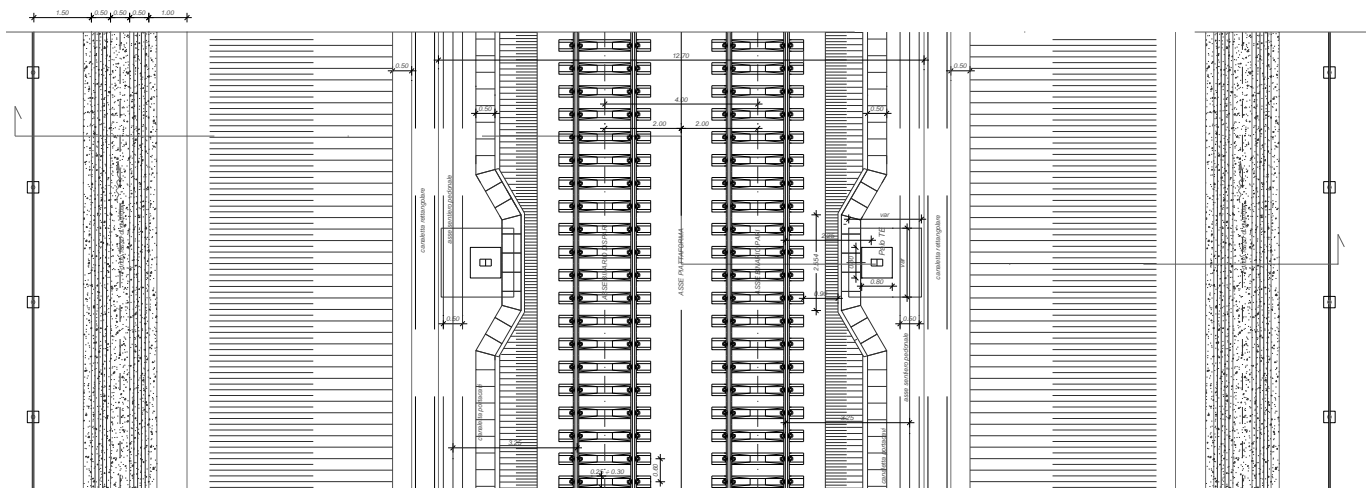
Stralcio planimetrico con sezione tipo ferroviaria in trincea a doppio binario in rettilineo
